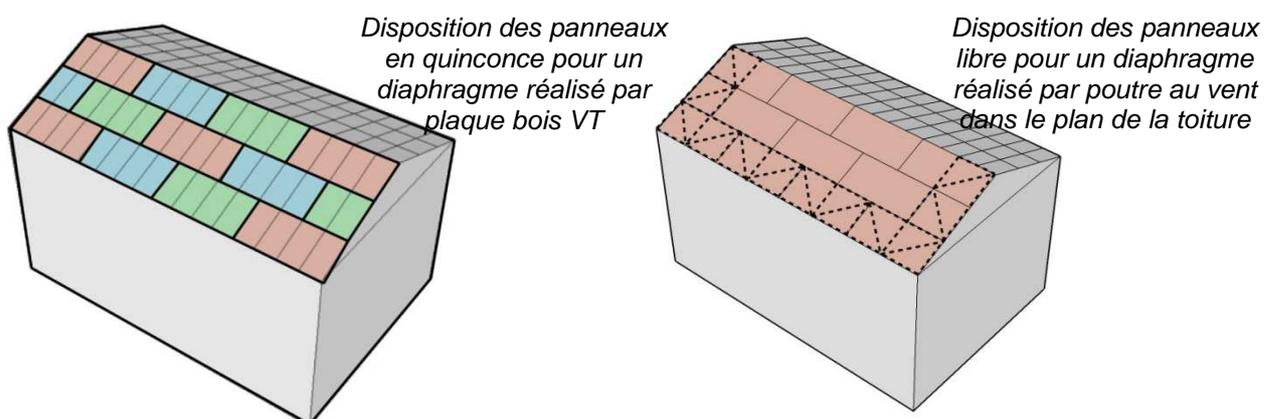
Principes de constitution du diaphragme en toiture à 2 versants, par plaques voile travaillant (à gauche) ou par poutres au vent (à droite).
